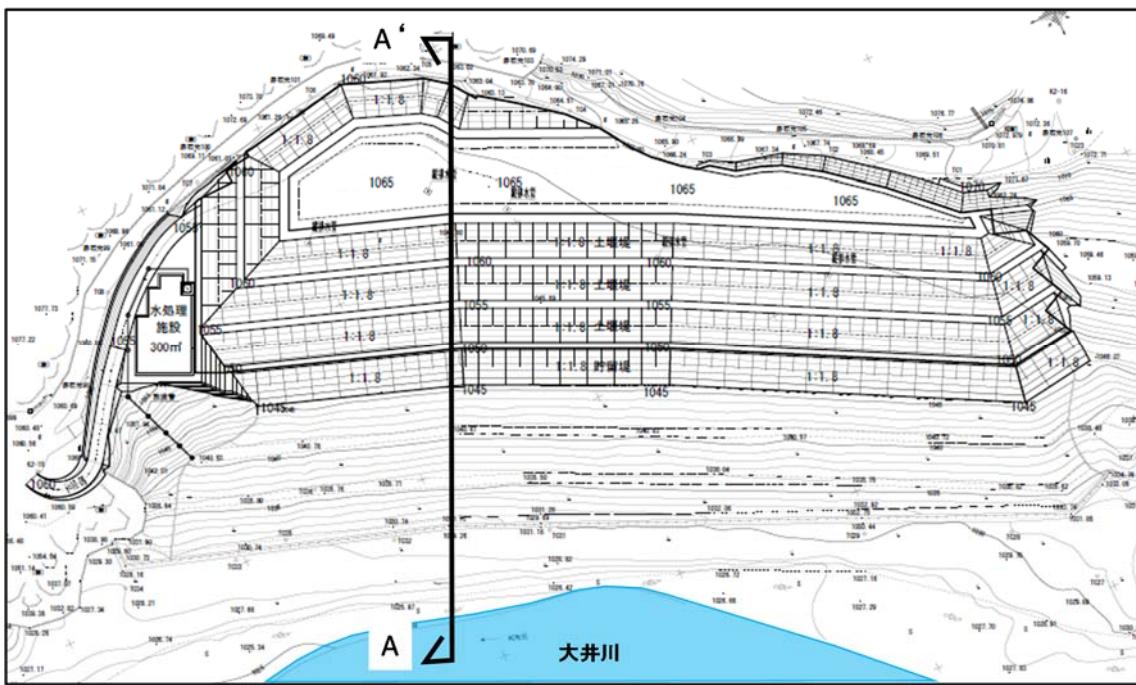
藤島沢付近の発生土置き場（遮水型）計画平面図
